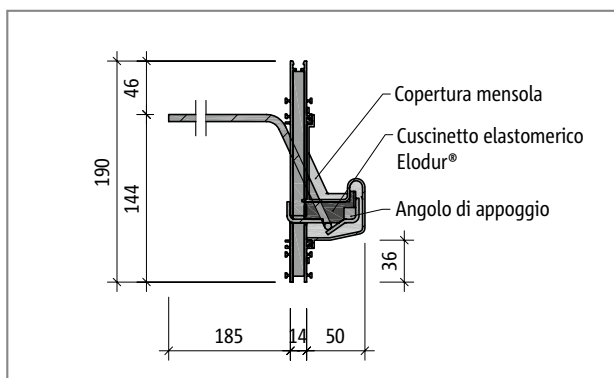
Schöck Tronsole® tipo T, sezione dell'elemento T...-H190 attraverso la mensola di supporto
